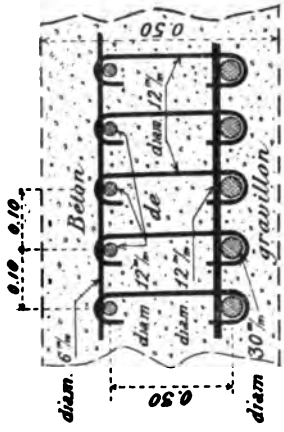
Coupe longitudinale de l'ossature (partie).
